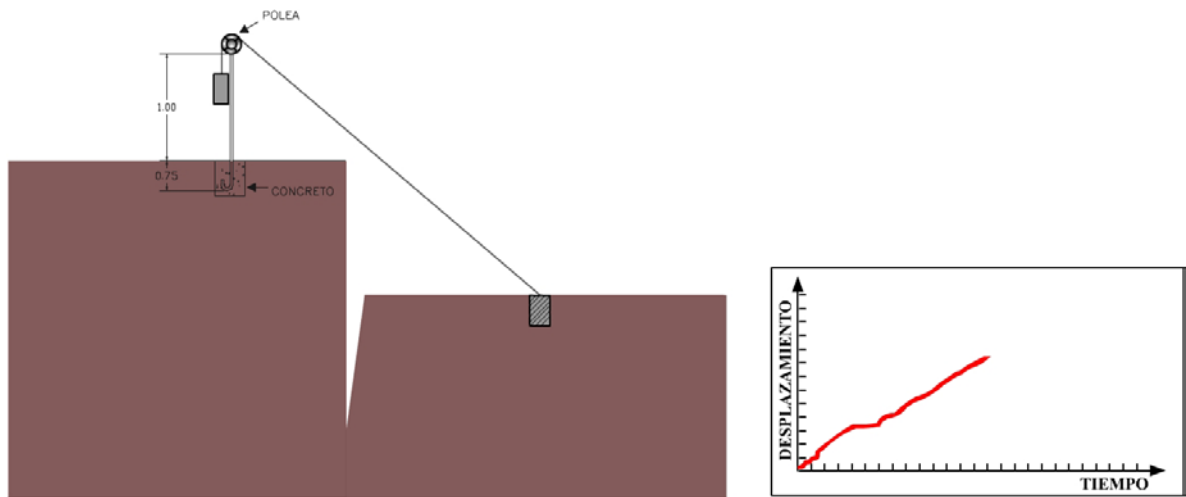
Detalle constructivo de los mojones de concreto
